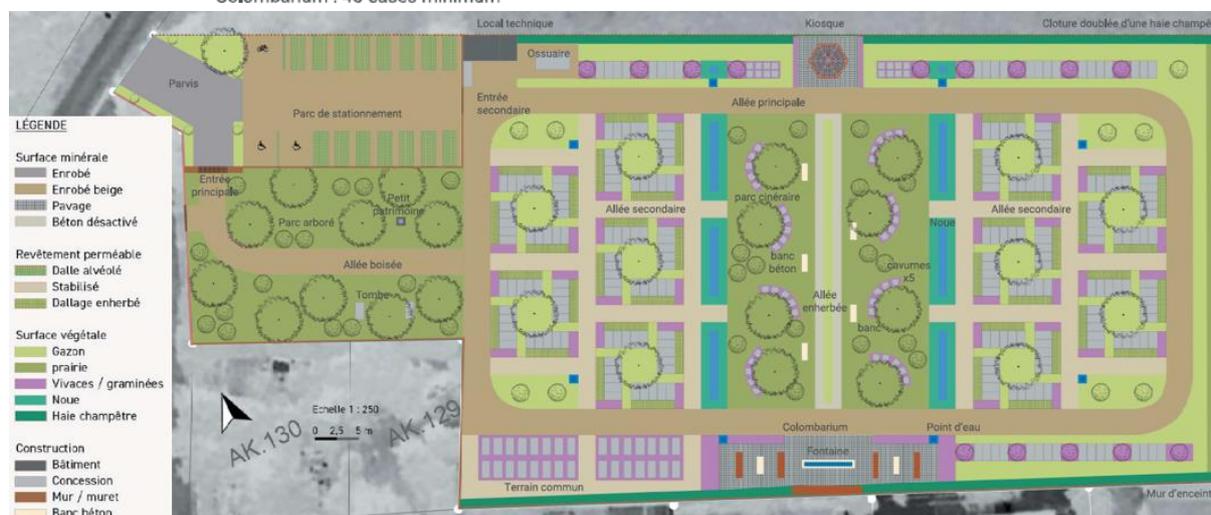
Plan d'aménagement de la phase 1 de l'extension du cimetière (d'après le plan Iris, BE VRD et Gaëlle Combres, BE Paysage)
